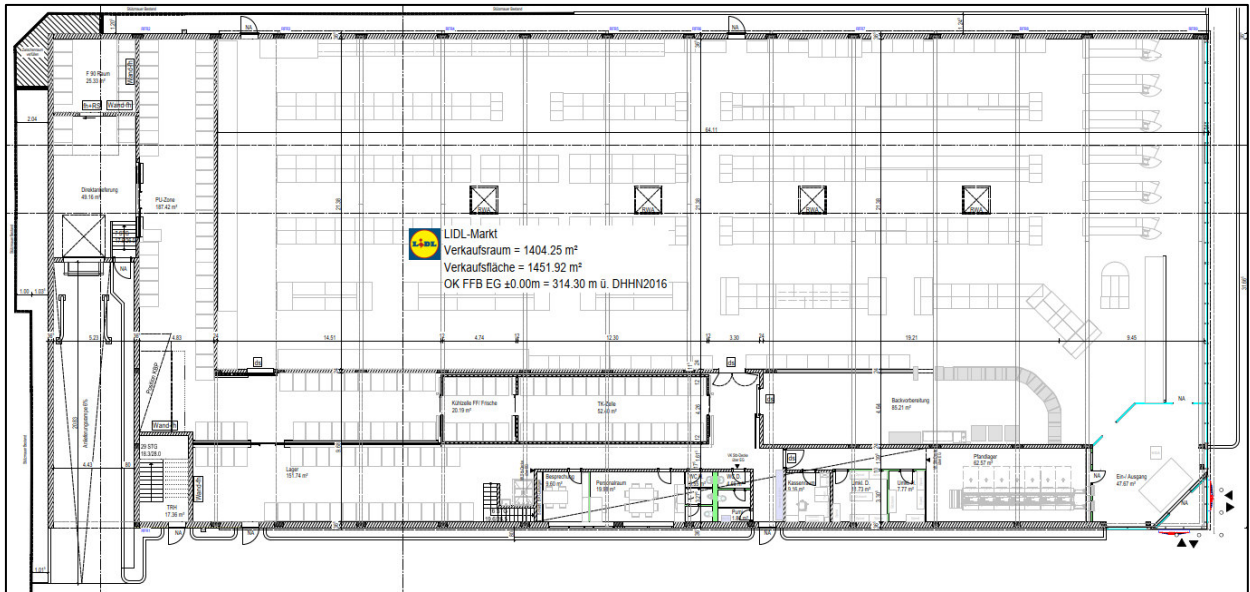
Grundriss Lidl-Markt Chemnitz, Fürstenstraße 5 (links Entladebereich im Gebäudeinneren) [2]
